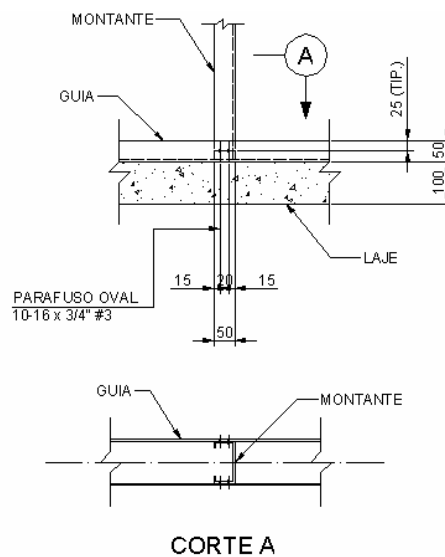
Detalhe construtivo da ligação Montante Simples - Guia [3]
